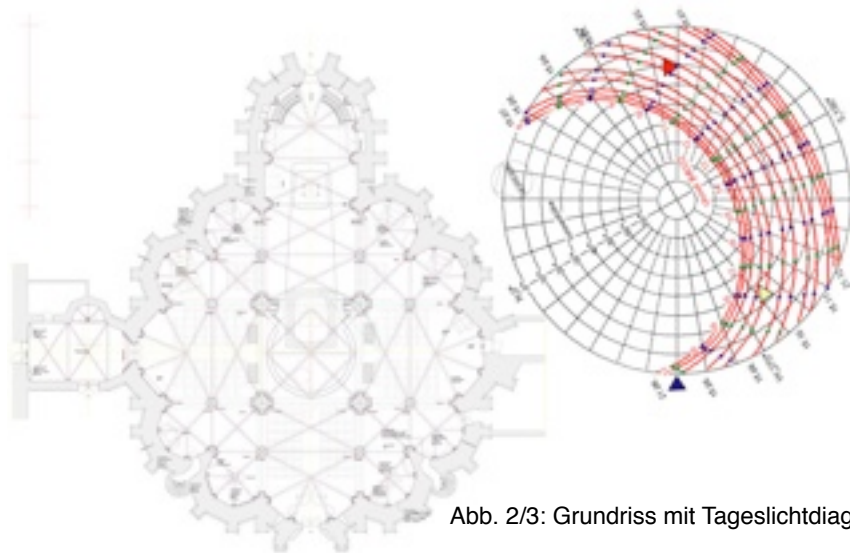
/3: Grundriss mit Tageslichtdiagramm
